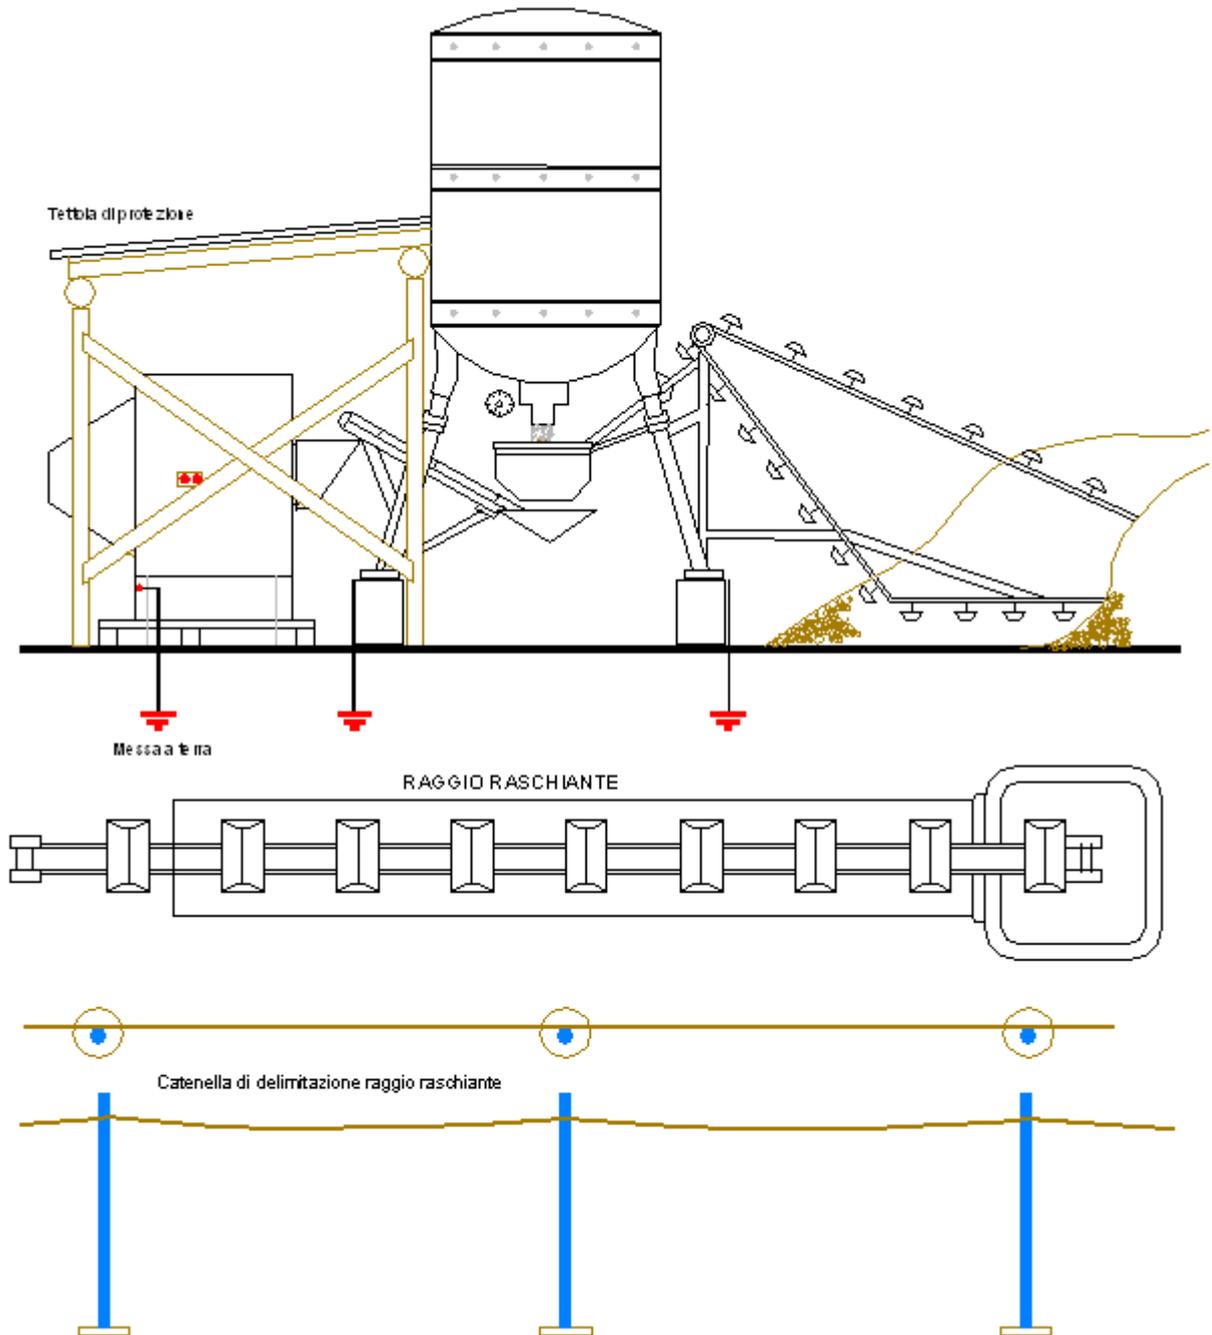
Protezioni area di lavoro centrale di betonaggio
